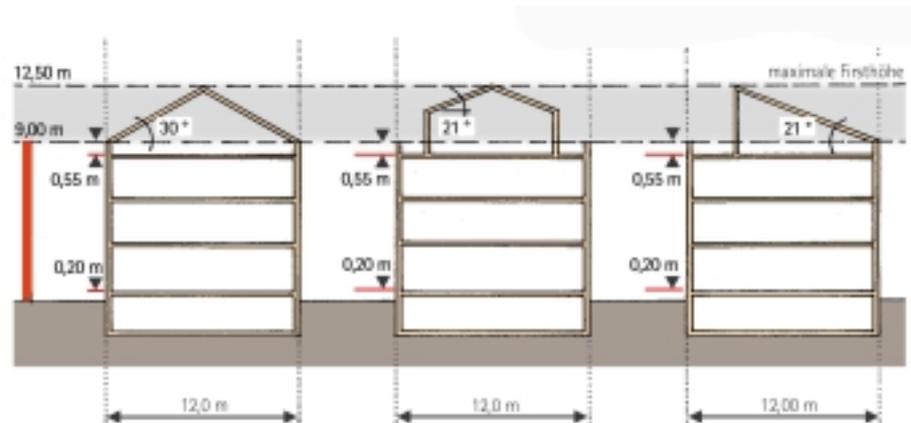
Beispiele für eine dreigeschossige Bebauung
